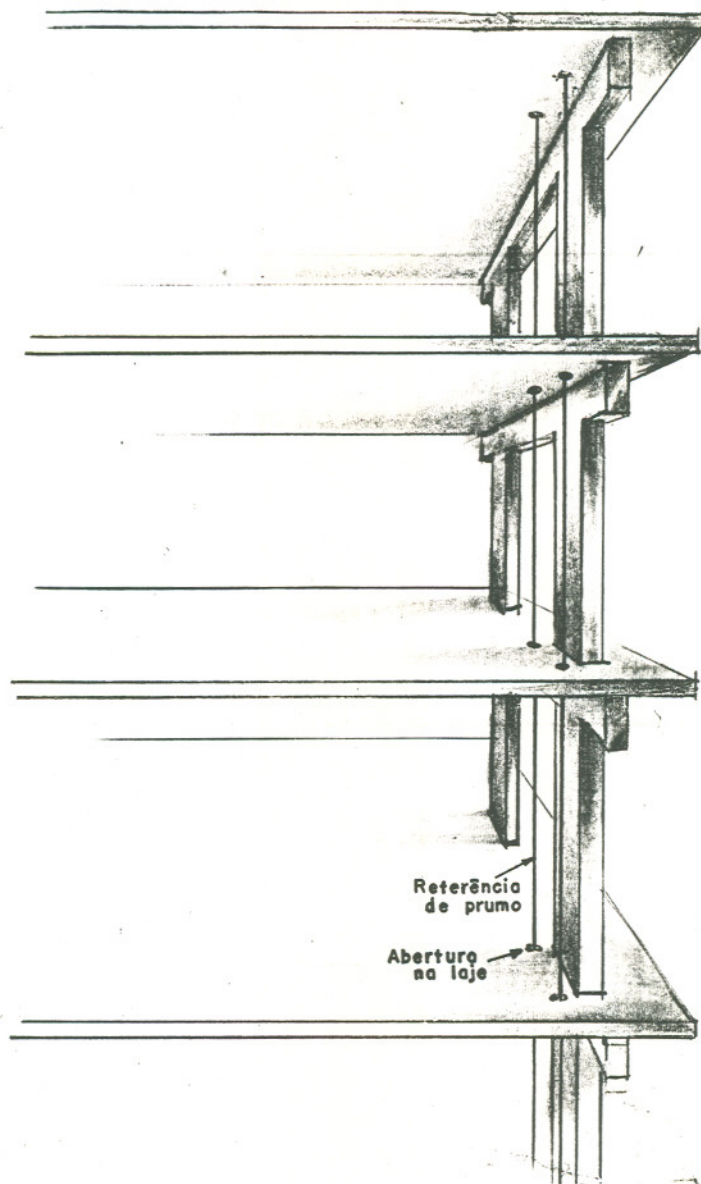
Ocorrência da excentricidade de pilares nos encontros com lajes (e vigas).
